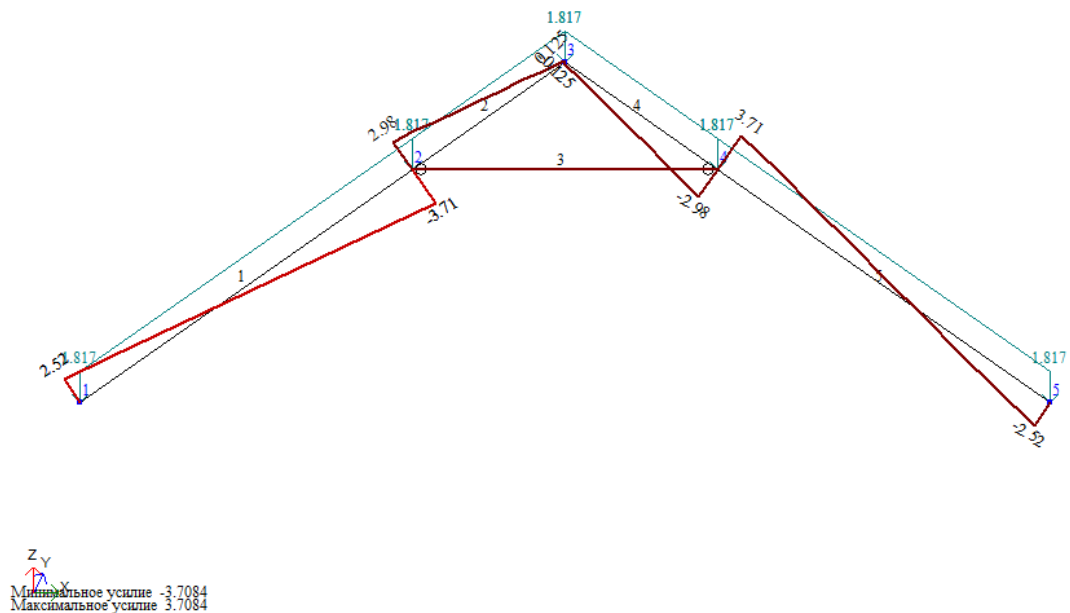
Епюра поперечних сил у кроквах.
